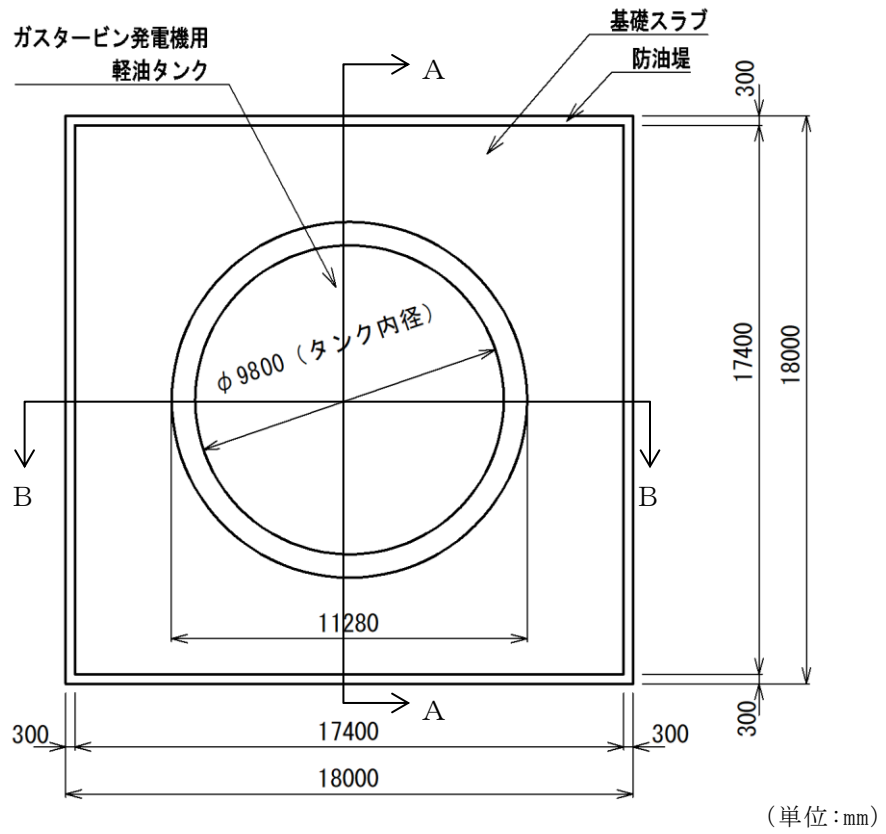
ガスタービン発電機用軽油タンク基礎 平面図
